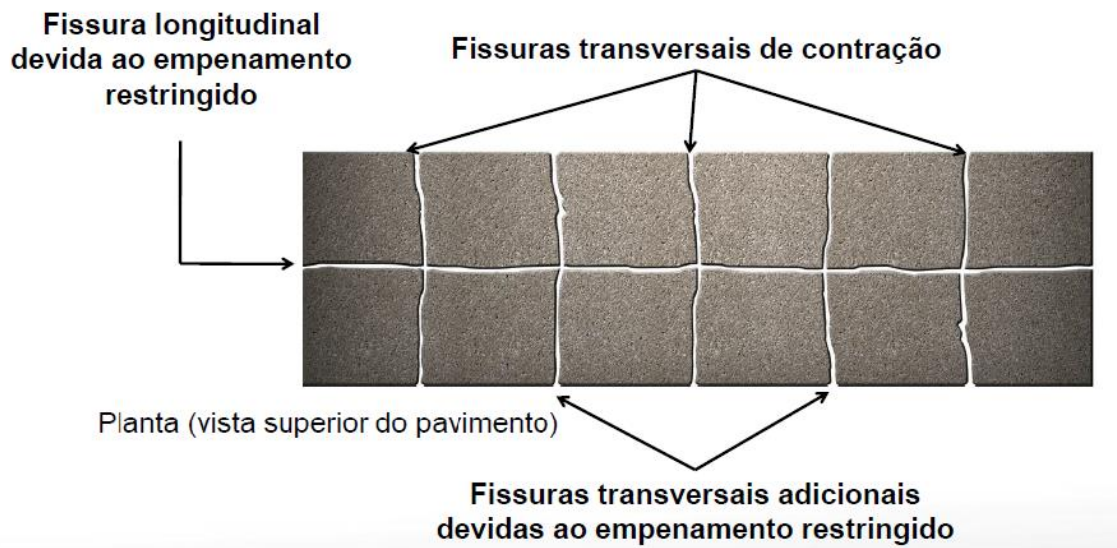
Aspecto superficial característico ocasionado pela ausência de juntas transversais e longitudinais em pavimentos de concreto simples. Em (a) fissuras transversais de retração; em (b) fissuras transversais adicionais e longitudinais devidas ao empenamento térmico restringido
